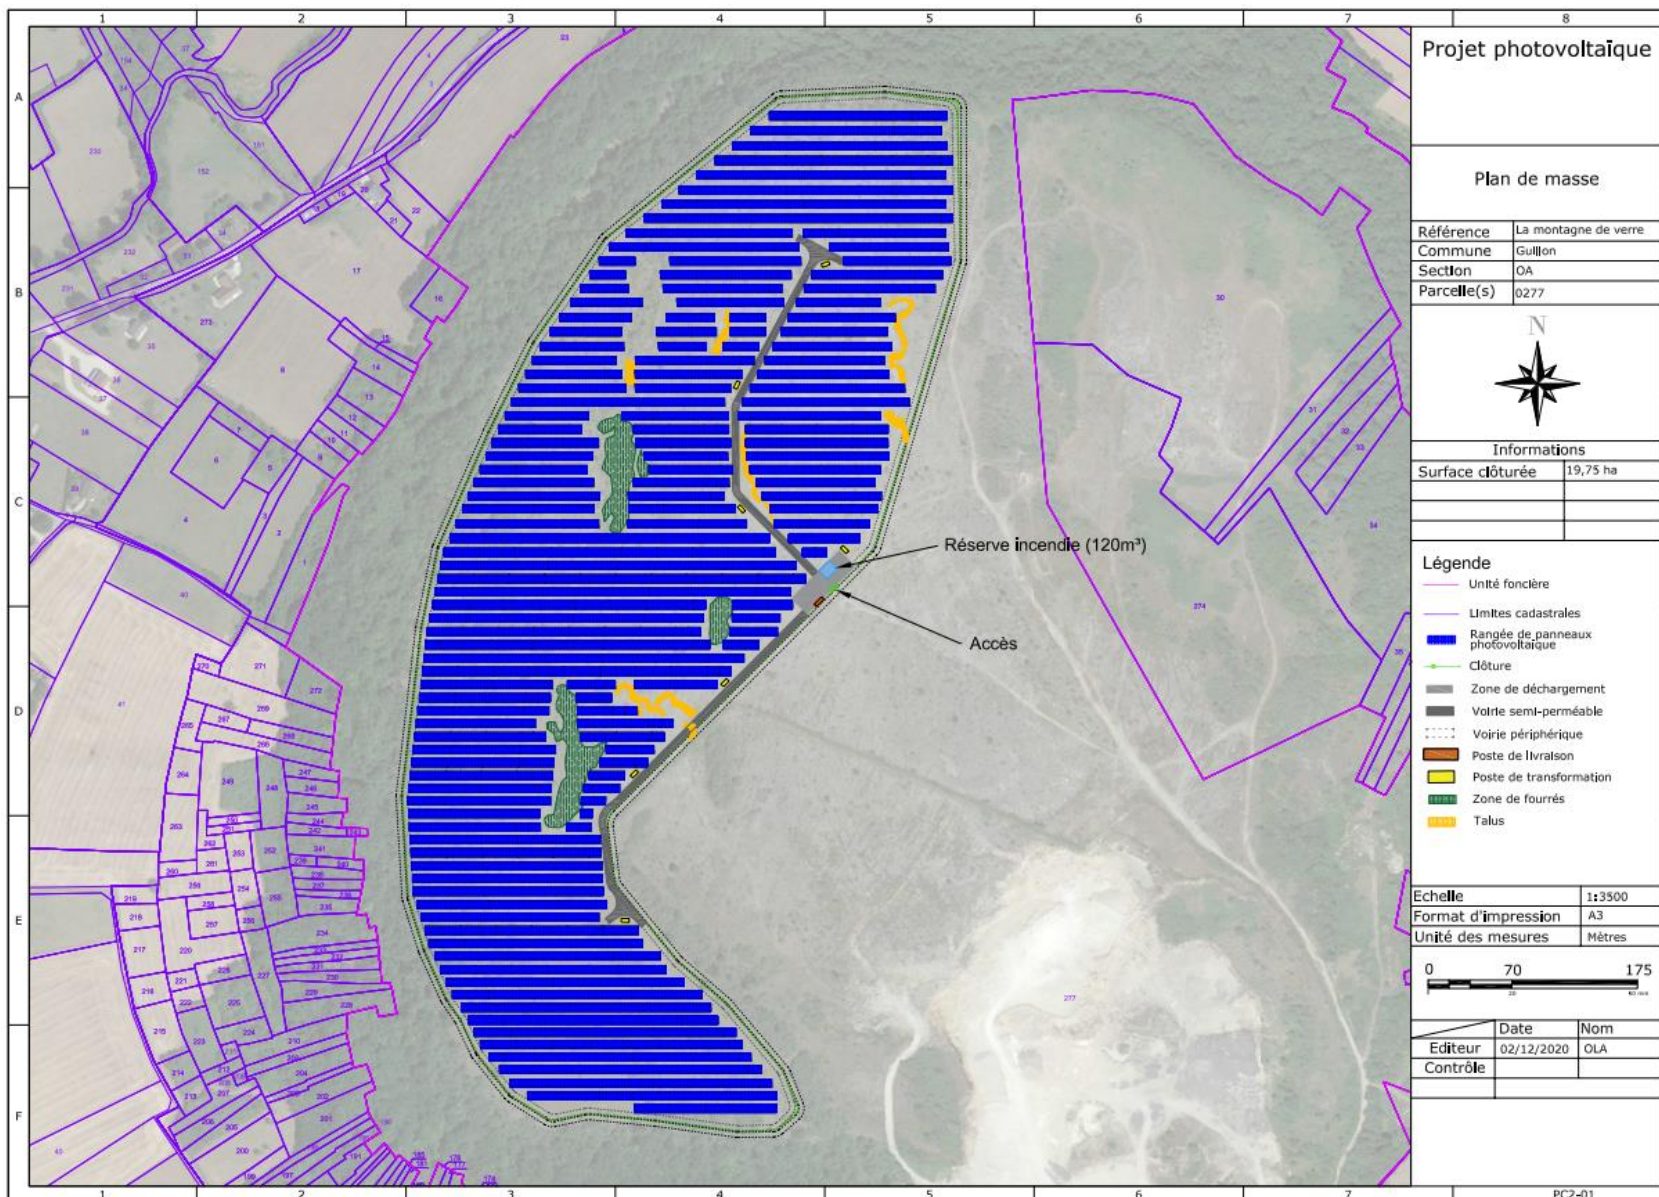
Plan de masse du projet photovoltaïque de la zone 2 – La Montagne de Verre (EDF Renouvelables)
